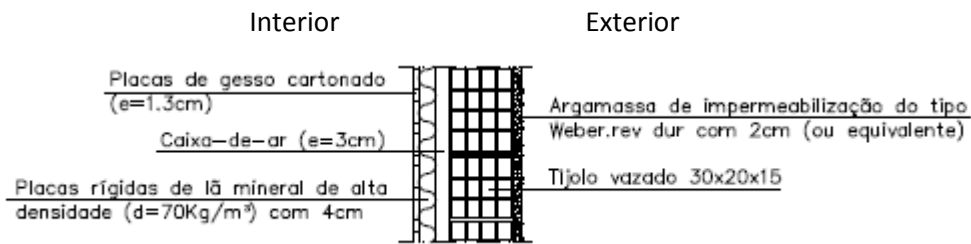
Pormenor construtivo da parede Pe3 [17]
